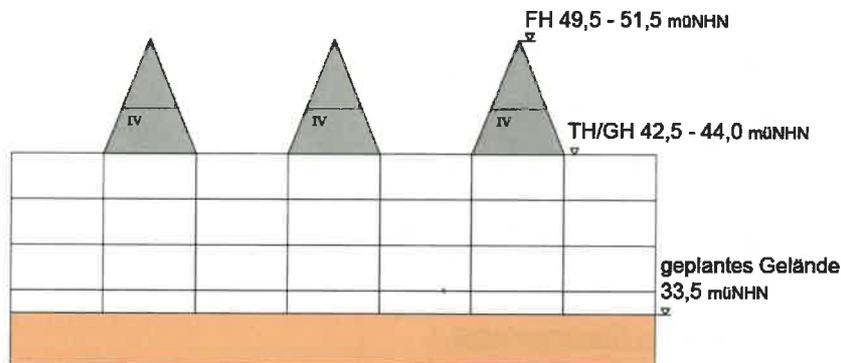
Schemaskizze - Frontansicht Bebauung Platzraum – WA 1 (ohne Maßstab)
